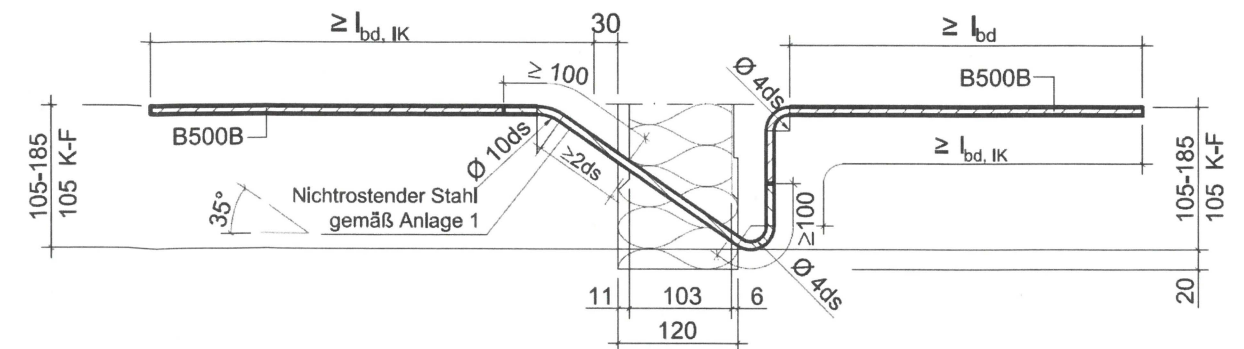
Typenplan Schöck Isokorb® XT Typ K und K-F 6.0
